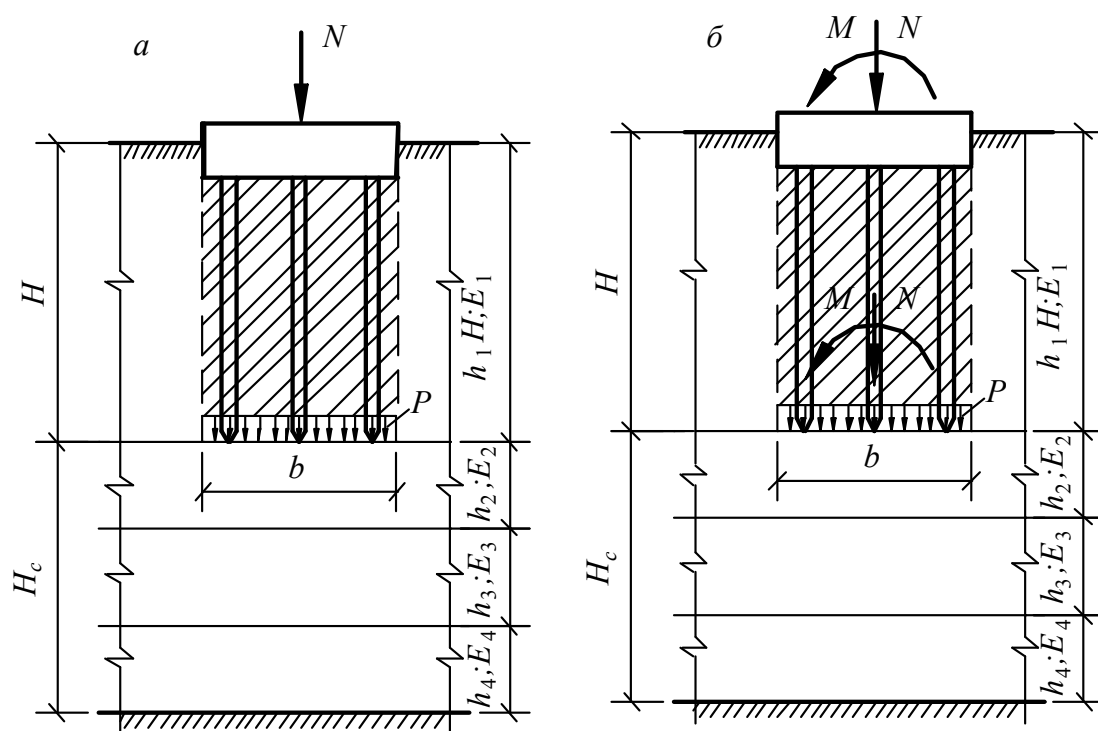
Схема розрахунку фундаментів із пальових полів:
